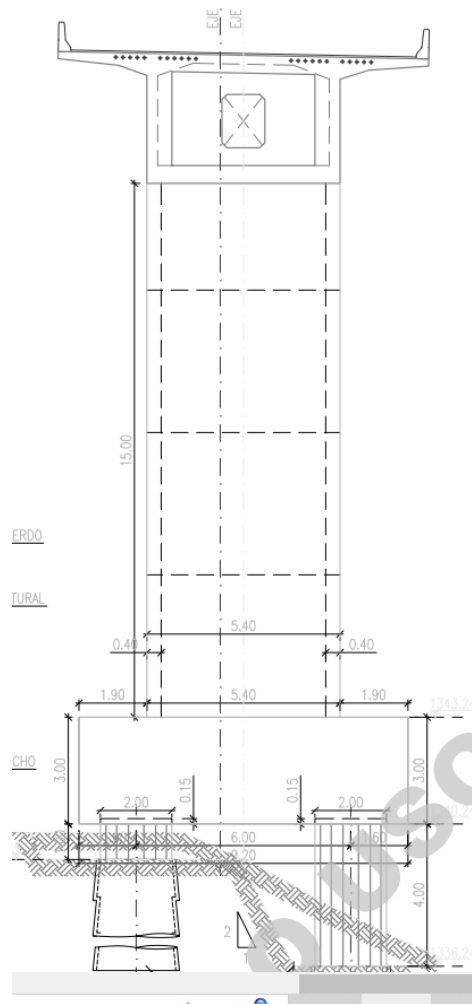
Perfil de la pila incluyendo tablero y cimentación
